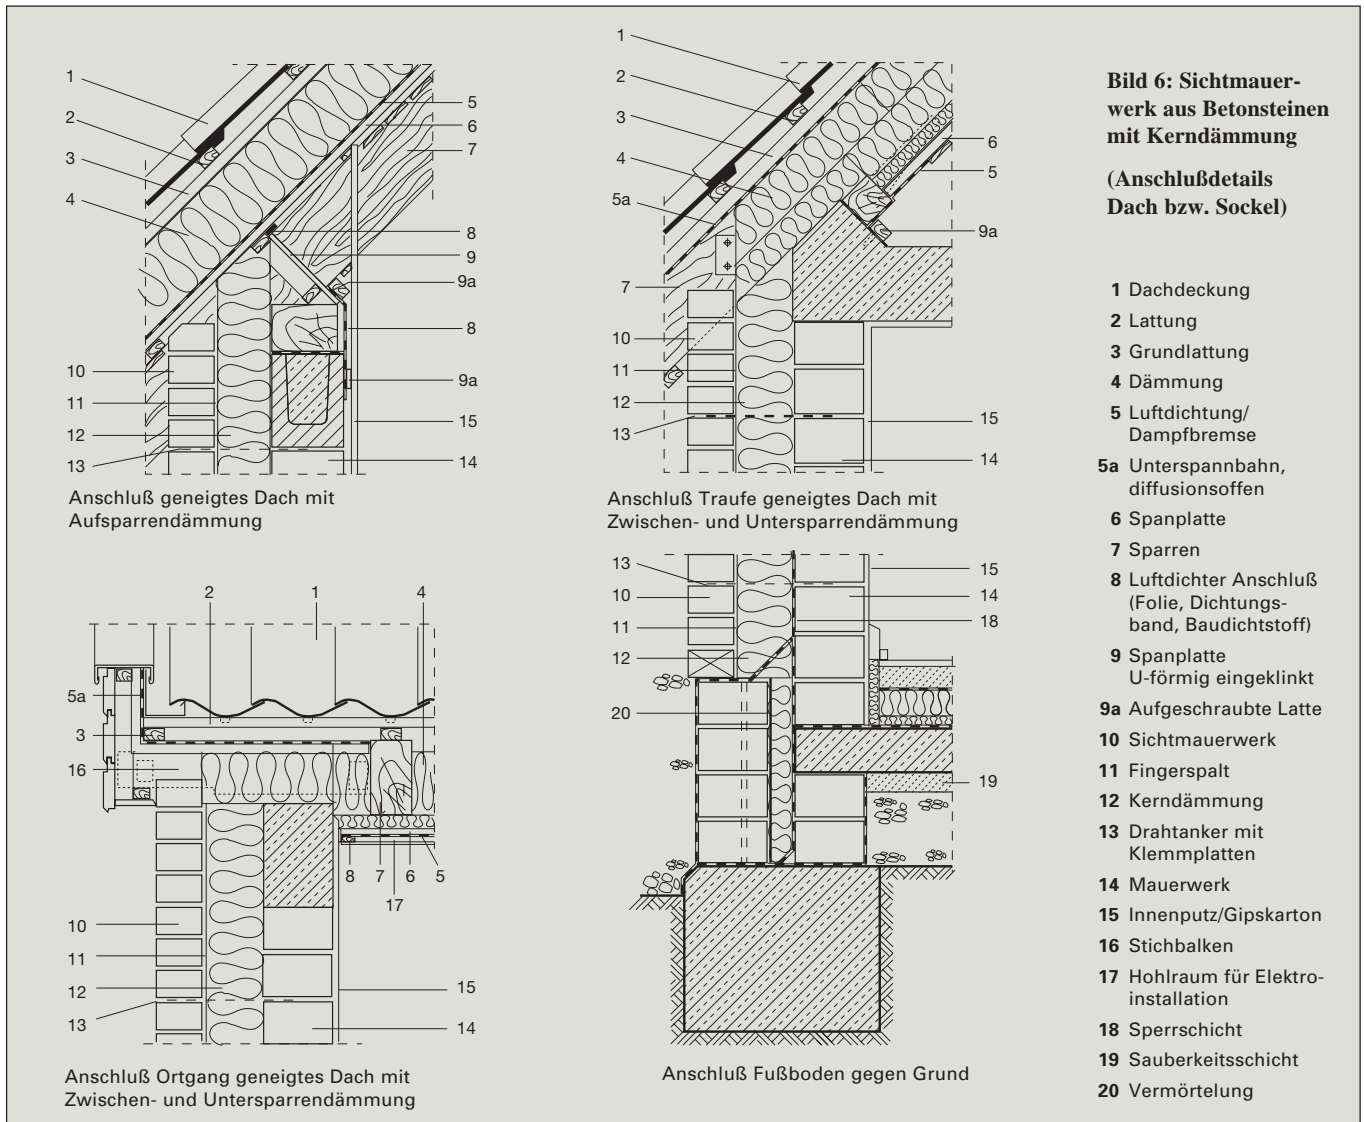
Sichtmauerwerk aus Betonsteinen mit Kerndämmung
